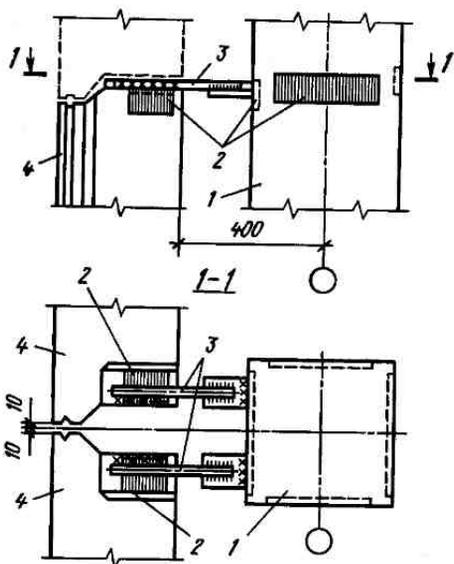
Узел крепления стеновых панелей к колонне каркаса:
